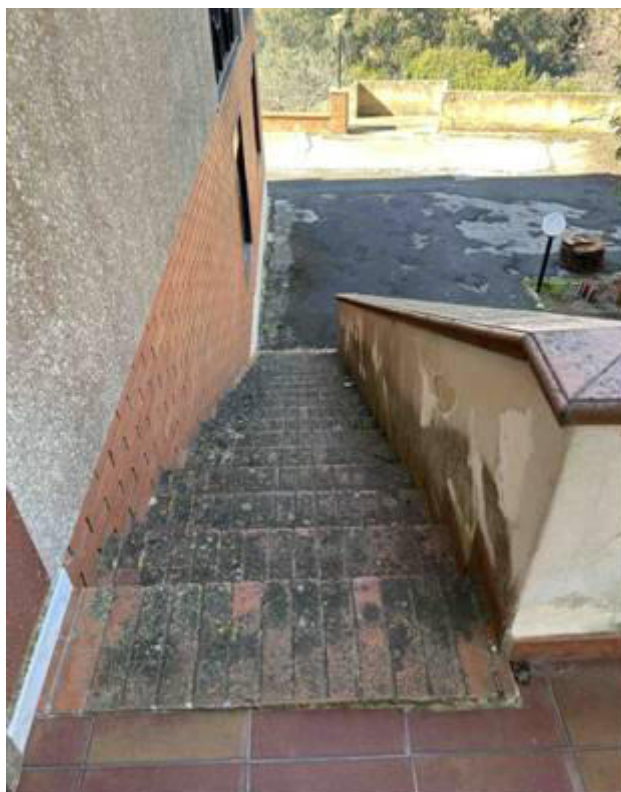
Foto scattata alla scala esterna al fabbricato che dal portico del piano rialzato si giunge al prospetto esposto a sud-ovest. La pedata e l'alzata della scala è in clinker colore cotto mentre la parete del parapetto è intonacata.
